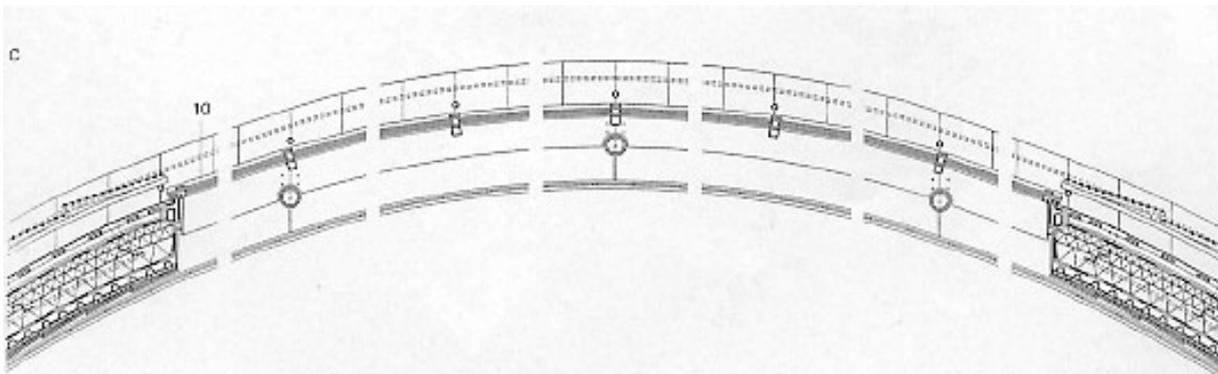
Rippen: Modell – Konstruktionsdetail - Deckenansicht
